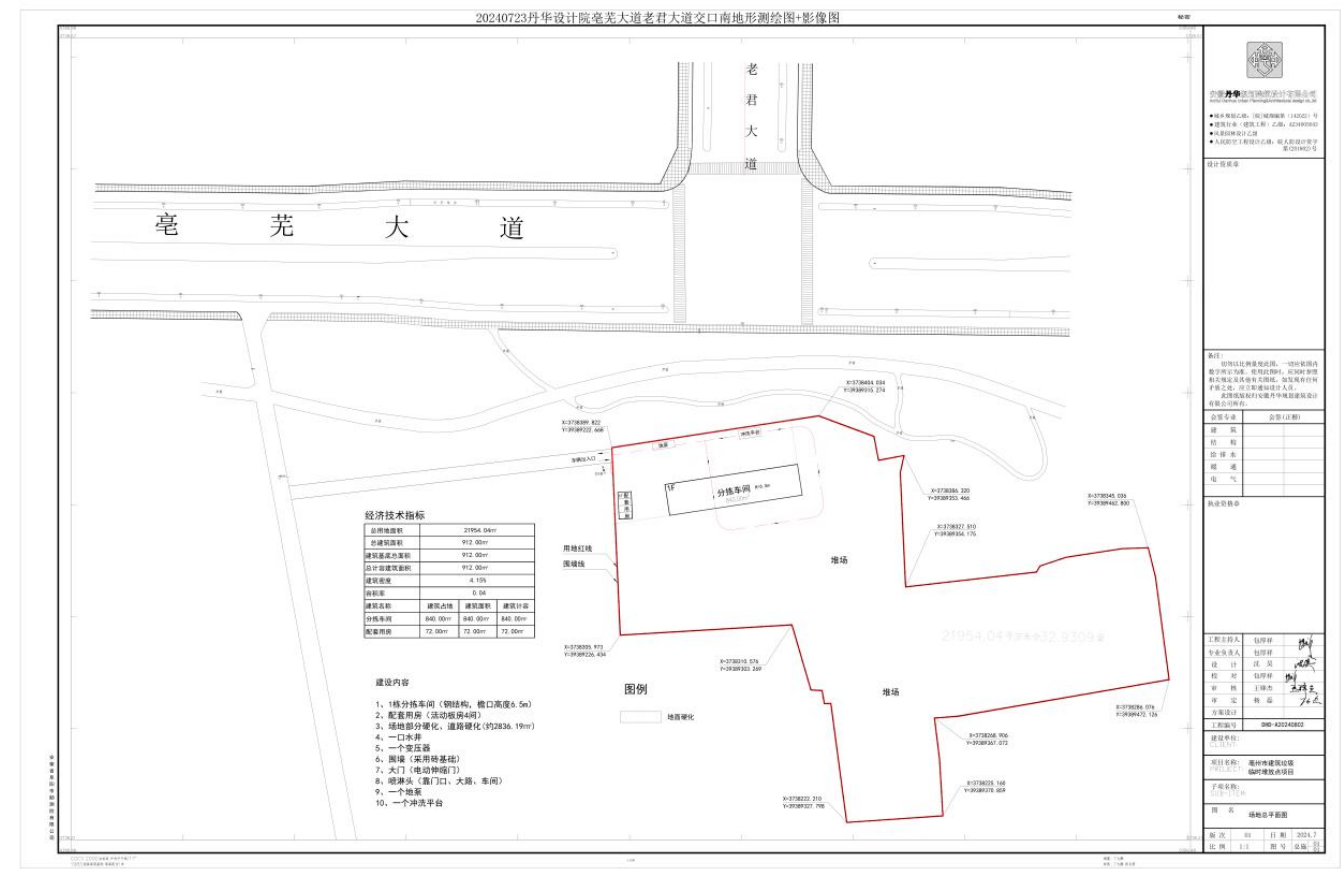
亳州市建筑垃圾转运调配厂平面图
